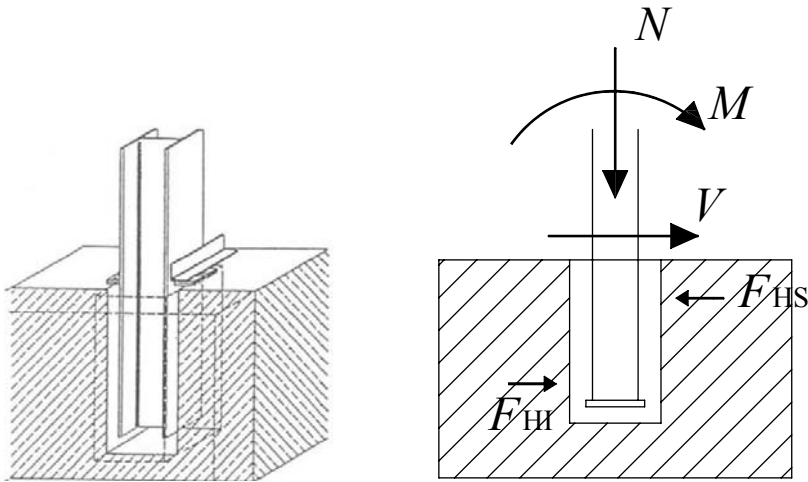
Fondation en fourreau supprimant la nécessité d'ancrages pour la reprise de M en pied de poteau.
